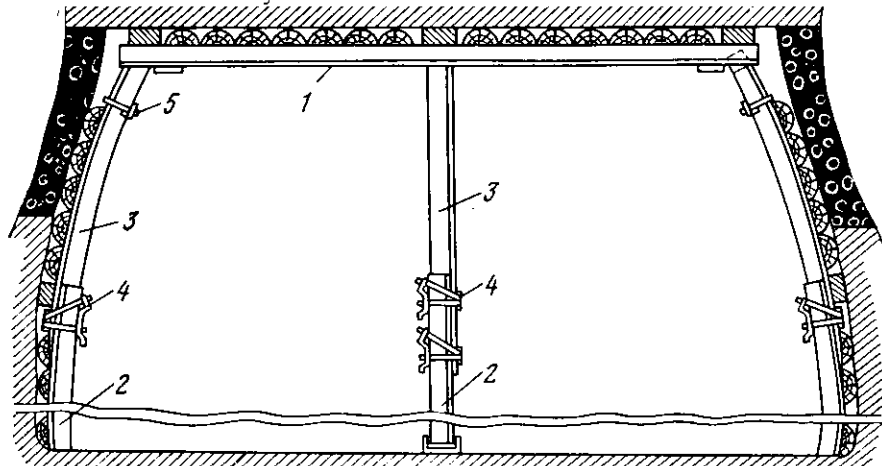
Металлическая трапецевидная податливая крепь: 1 – верхняк; 2 – нижний отрезок стойки; 3 – верхний отрезок стойки; 4 – соединительный замок; 5 – стяжка
